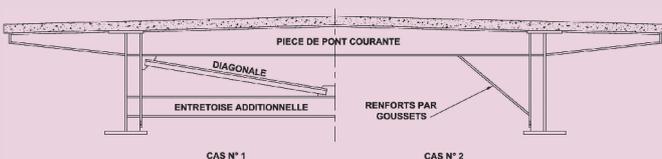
Pièces de pont encadrant les pièces de pont sur piles
